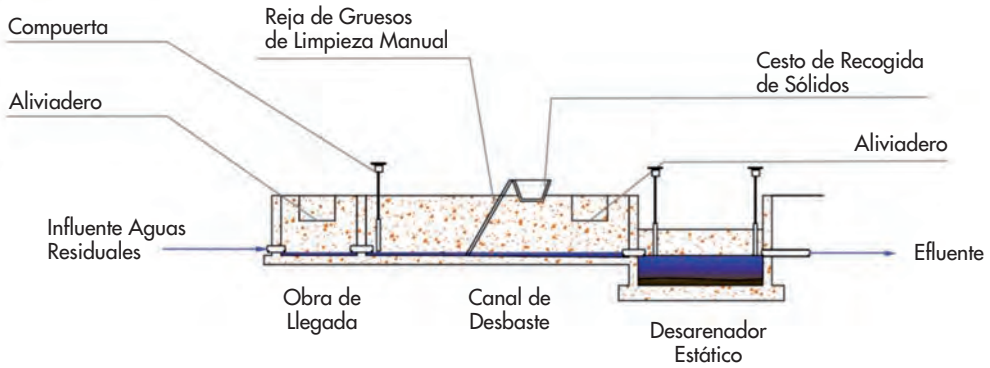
Planta de un pretratamiento con desbaste y desarenado de limpieza manual
